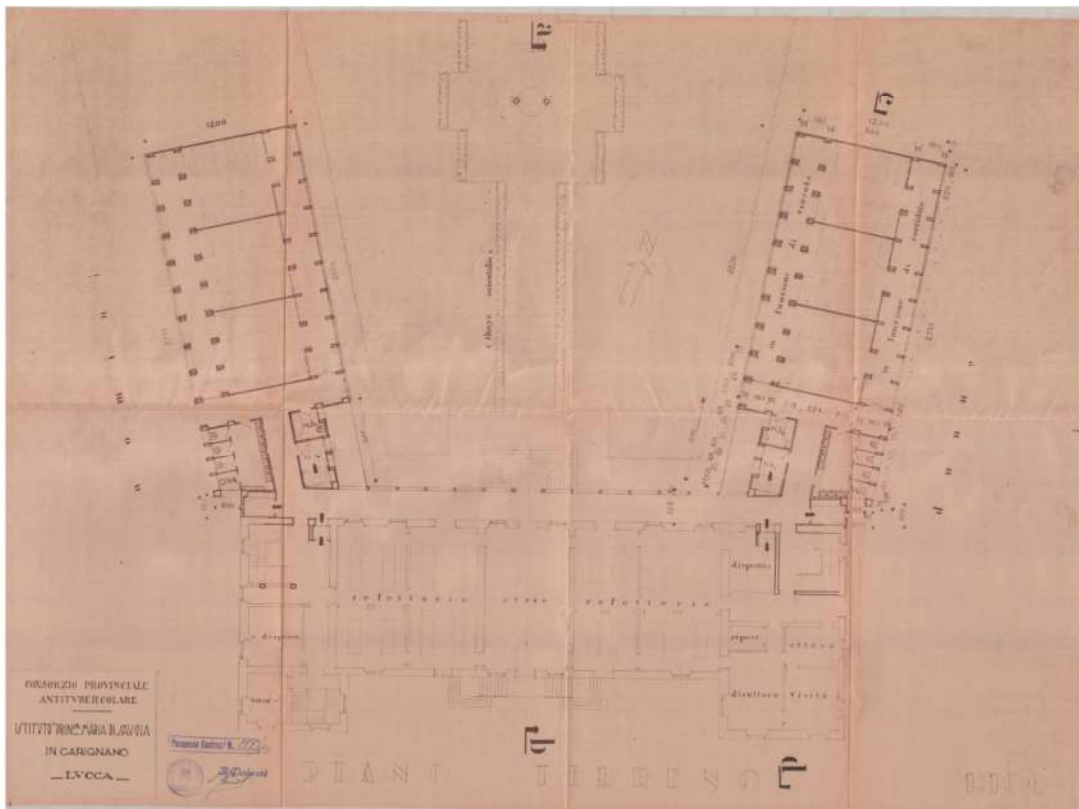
pianta piano terreno con l'ampliamento delle ali in c.a..
